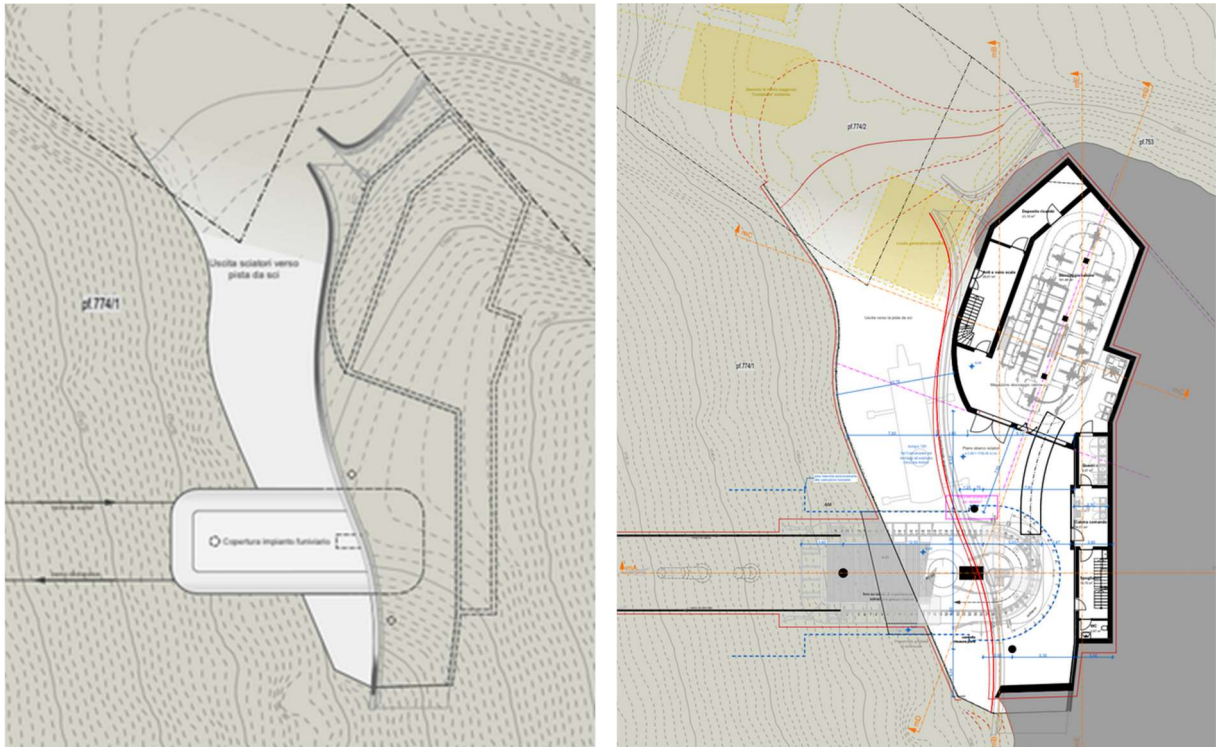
pianta e planimetria del piano di imbarco/sbarco della stazione di monte - architettonico
